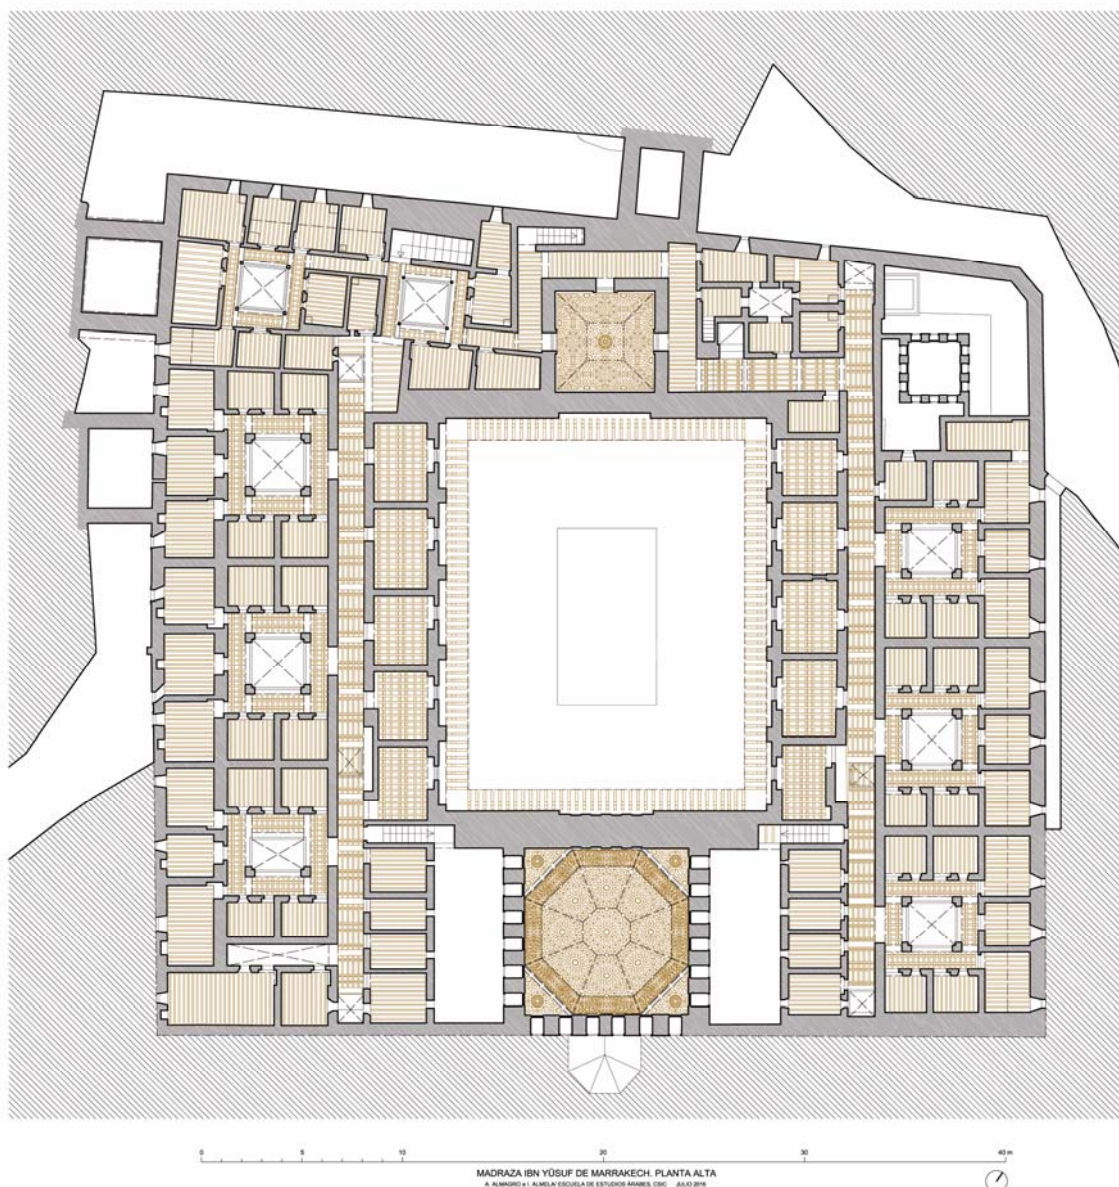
Madraza Ibn Yūsuf. Planta alta.
